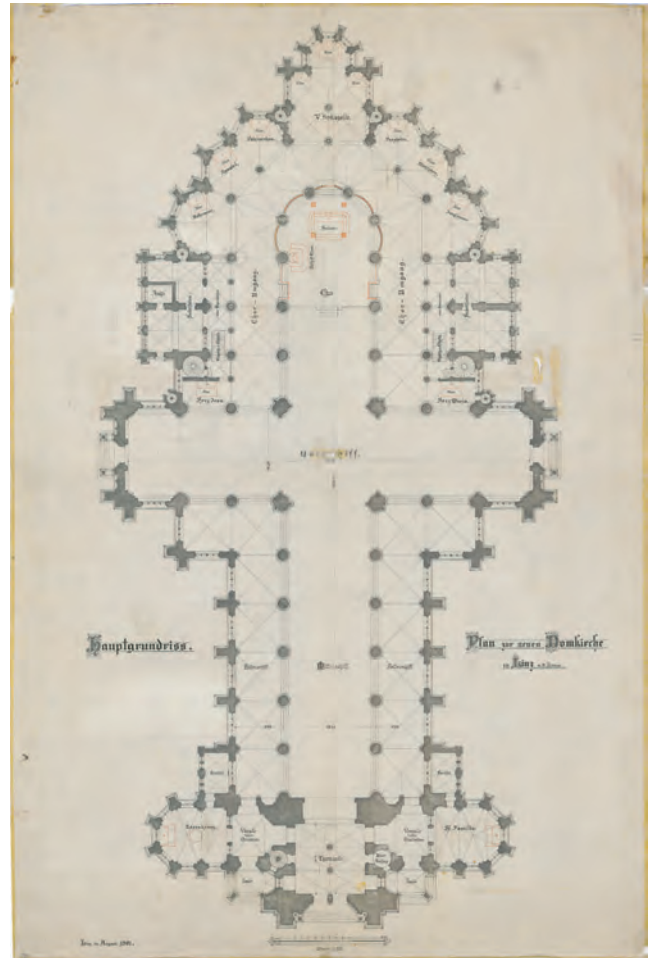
Lichtpause und Umzeichnung, 1901, nach Vincenz Statz, Linzer Mariendom, Haupt-Grundriss, wohl 1859
